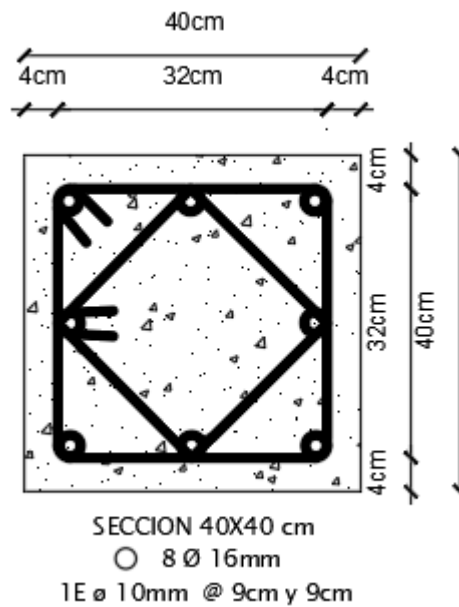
Distribución del acero en la columna de hormigón, estructura de acero.
